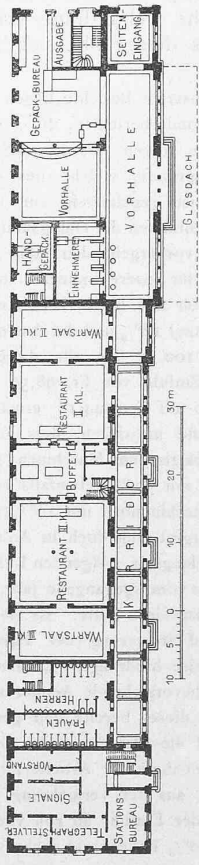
Grundriss vom Erdgeschoss des neuen Aufnahme- und Verwaltungsgebäudes im Bahnhof St. Gallen. — Masstab 1:1000.
